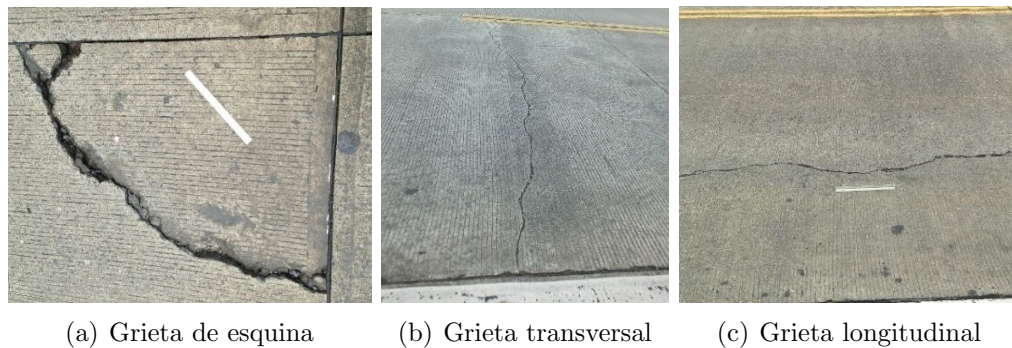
Fisuras estructurales que presenta un pavimento rígido.
